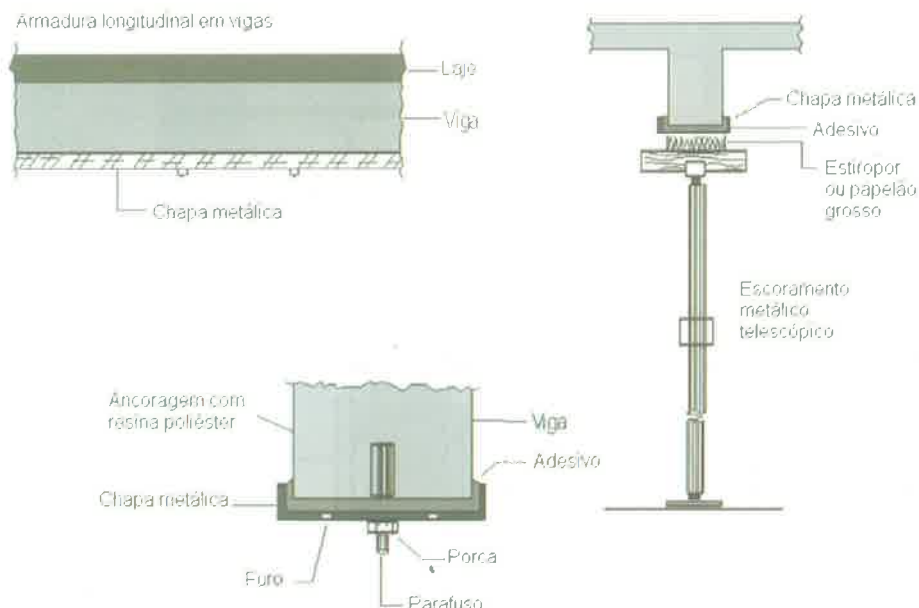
Reforço de flexão em vigas com chapas metálicas aderidas com epóxi.
